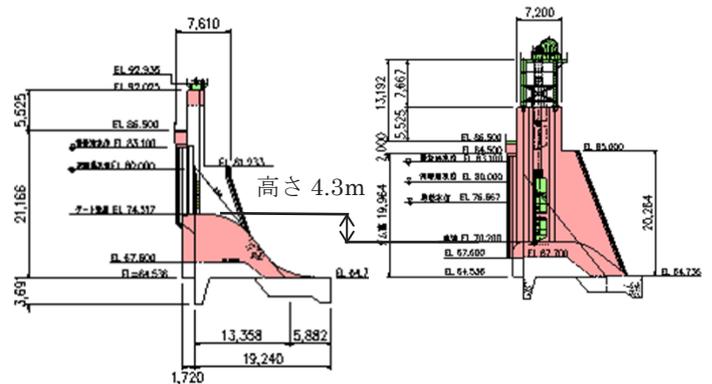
ダム改造工事計画図 (Dam renovation work plan diagram)
